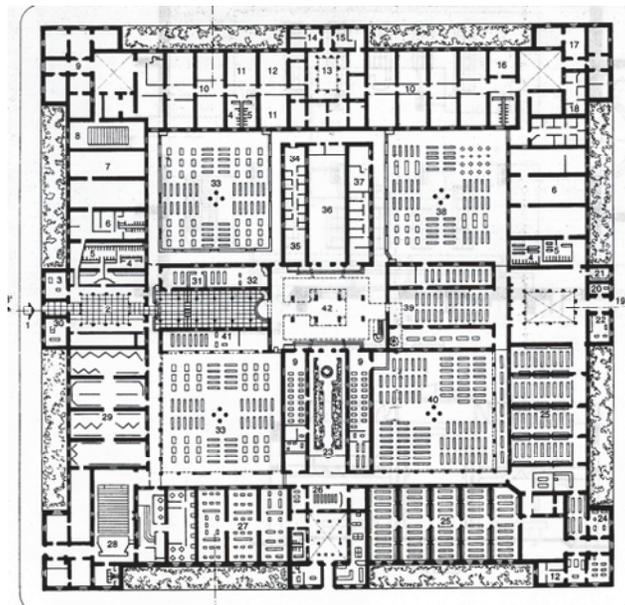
Planta de la Biblioteca México en la Ciudadela tomada por A.Z.
